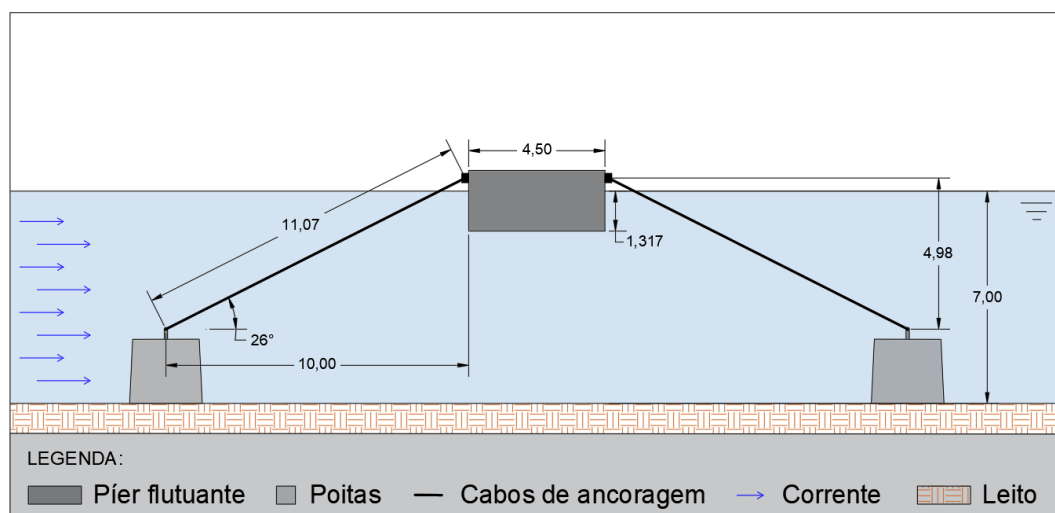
Corte transversal do *layout* do sistema de fundeio proposto em período de seca.
